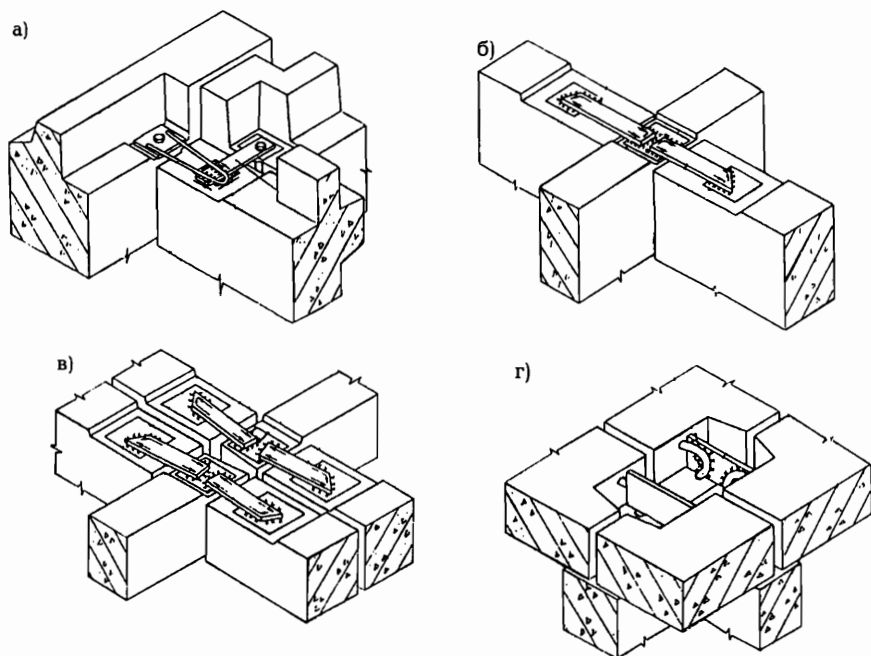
Операционно-технологические схемы полуавтоматической сварки основных узлов соединений крупнопанельных жилых домов: а - выступающей и западающей панелей наружной стены с поперечной стеной лестничной клетки, б - поперечных и продольной внутренних стен; в - то же, в зоне температурно-осадочного шва; г - панелей перекрытия между собой
